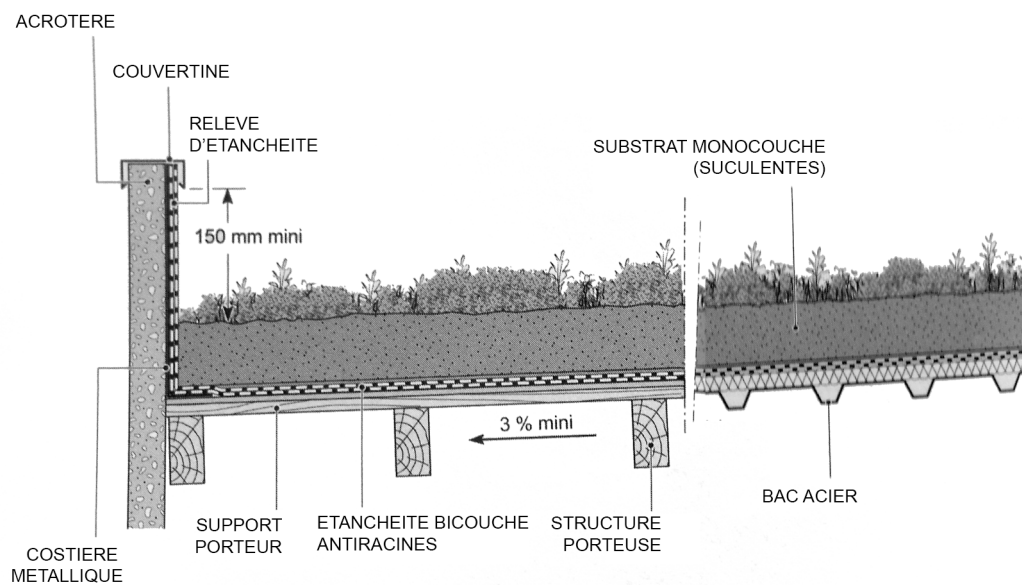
COUPE TYPE D'UNE TOITURE VEGETALISEE EXTENSIVE SUR SUPPORT EN BOIS / TOLE D'ACIER NERVURE (LASALLE, 2008).
